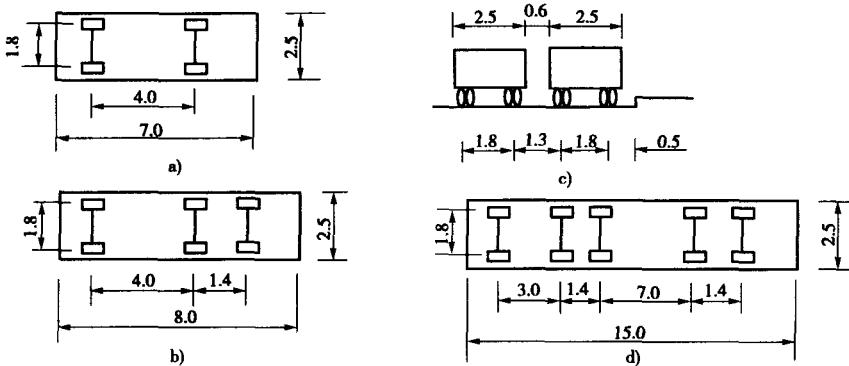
各种设计车辆平面尺寸和横向布置图(尺寸单位:m)
